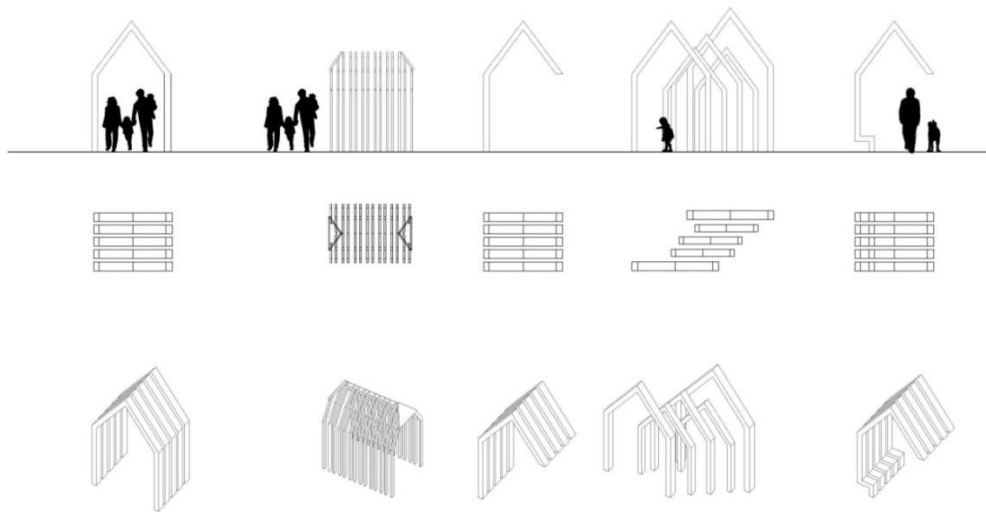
Tipet e siluetave të drunjtë të shpërndara gjatë Parkut të Lumit.
